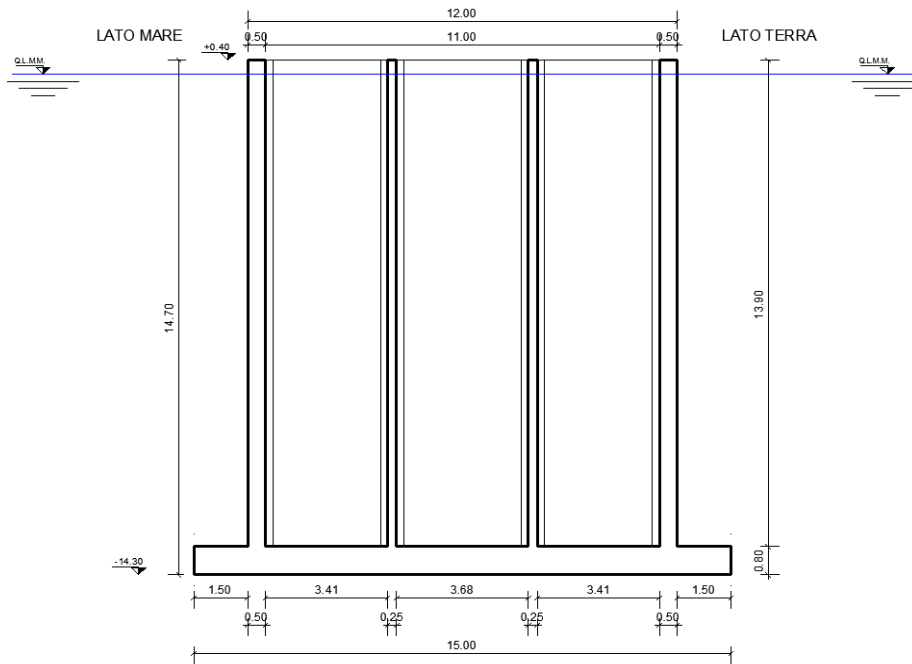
Carpenteria dei cassoni. Sezione B-B
